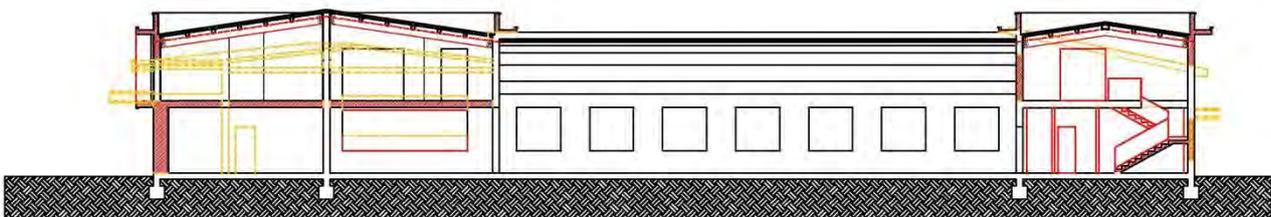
Tipologia di progetto prospetto sud stato sovrapposto
